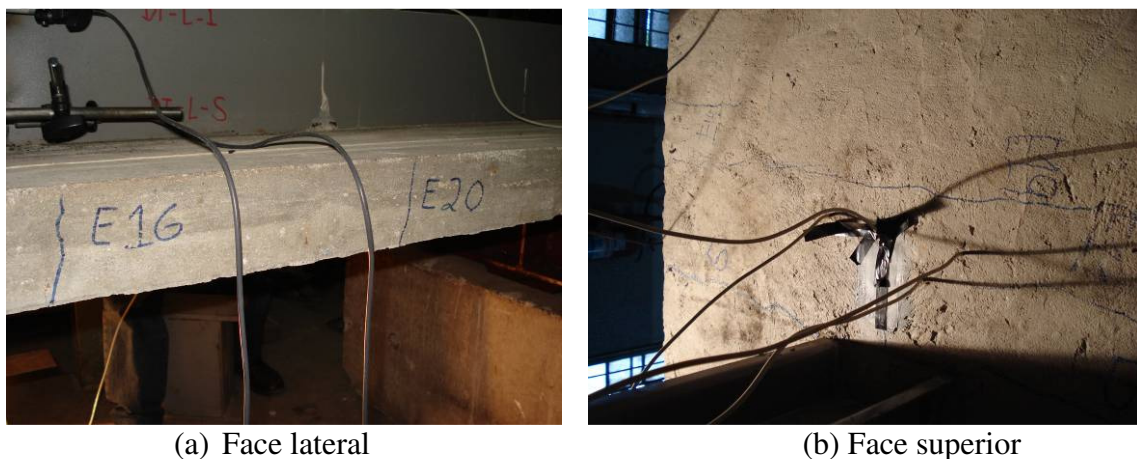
Fissuração do modelo 3A.
